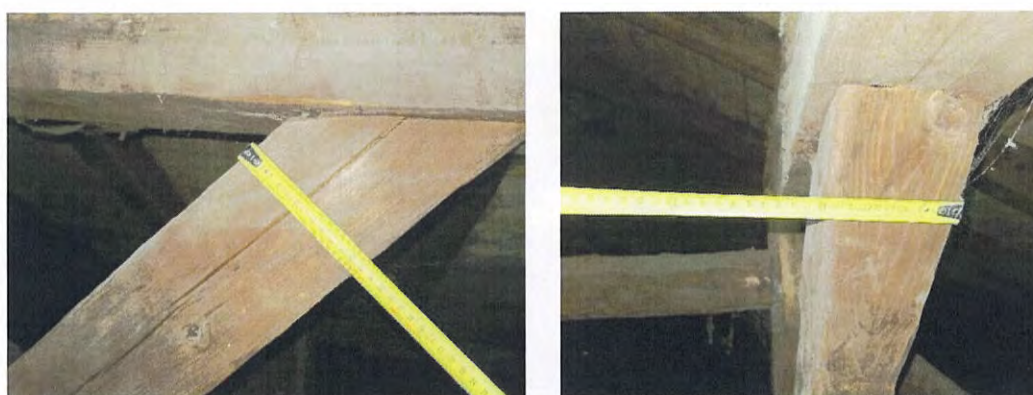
a, b– Aspect sondaje elemente șarpantă – contrafișă
